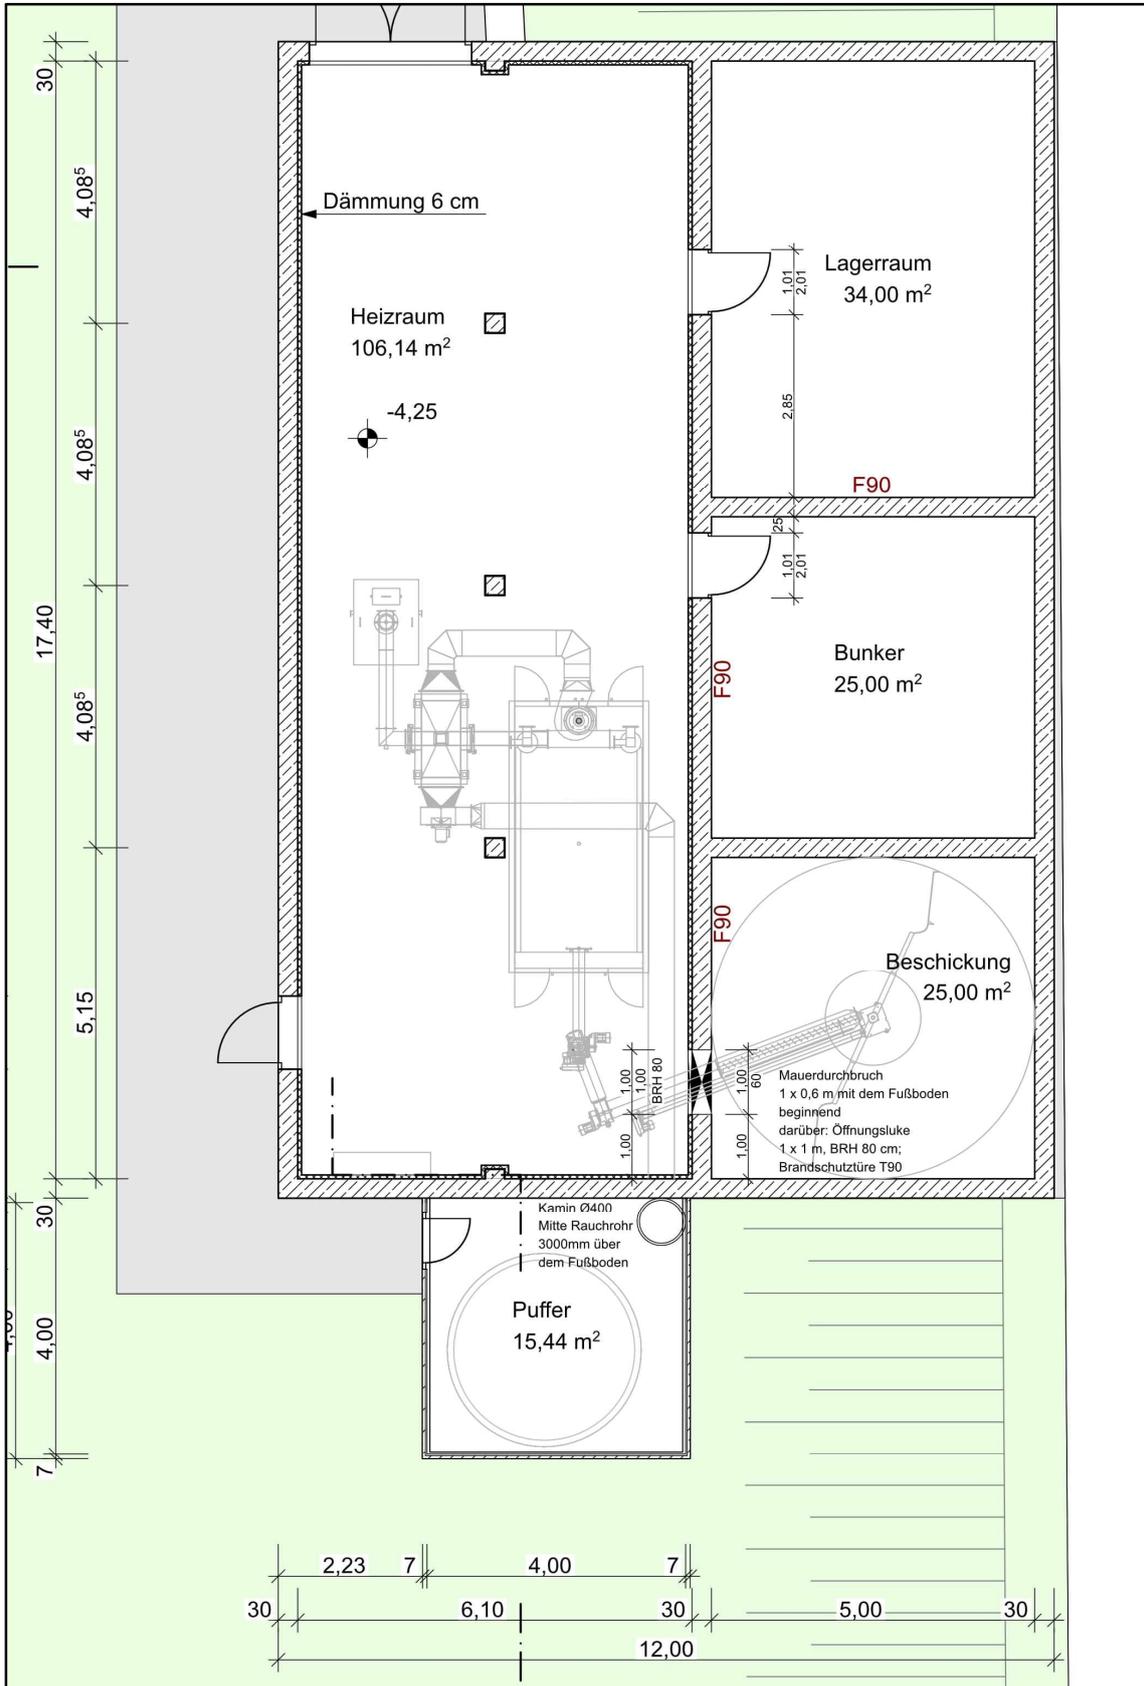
Grundriss des bestehenden Heizgebäudes
